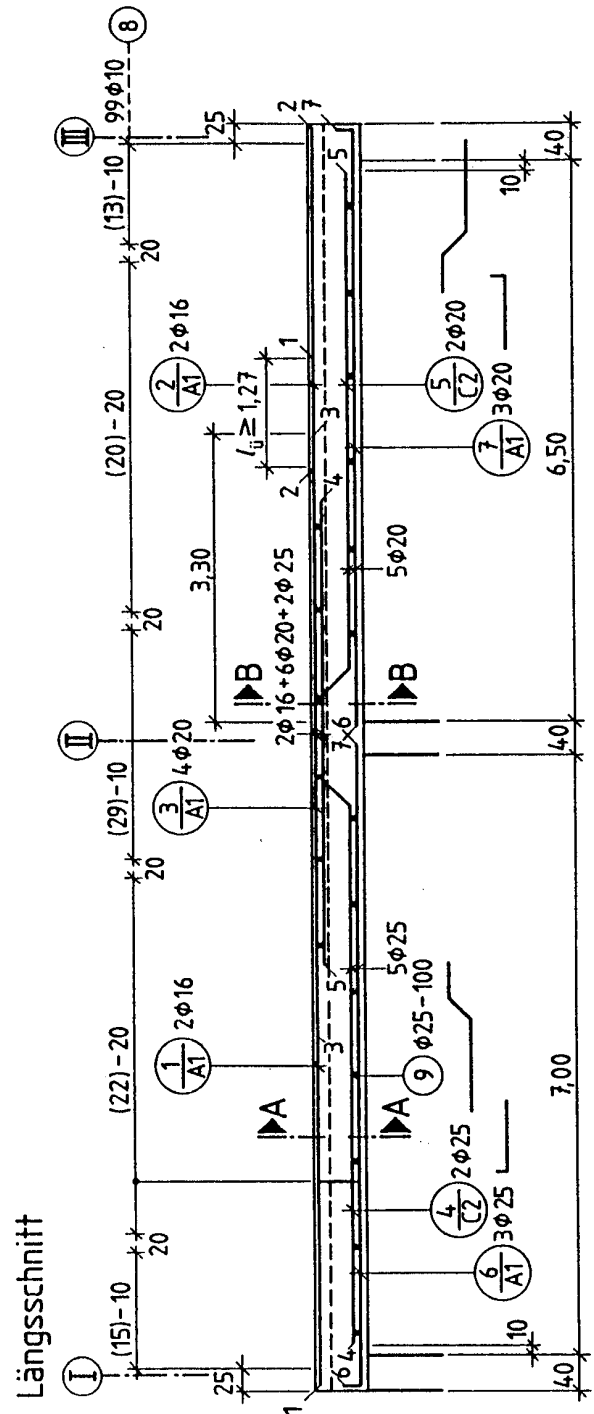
Bewehrungsplan für einen Stahlbetonunterzug (Darstellungsart 3)
